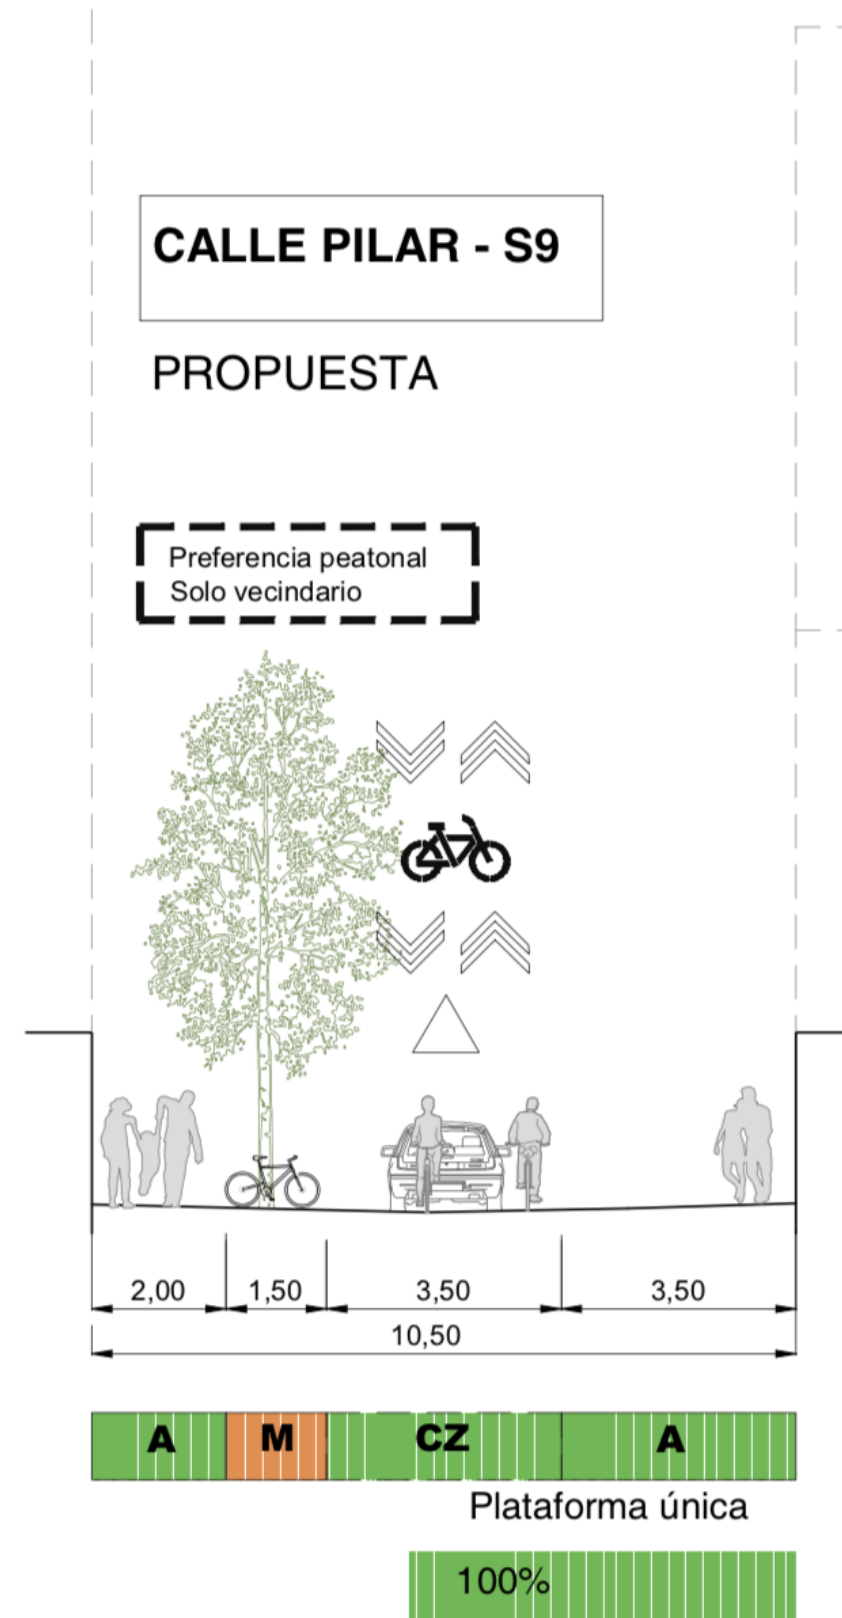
Sección propuesta en C. Pilar (S9). Fuente: Elaboración propia.
